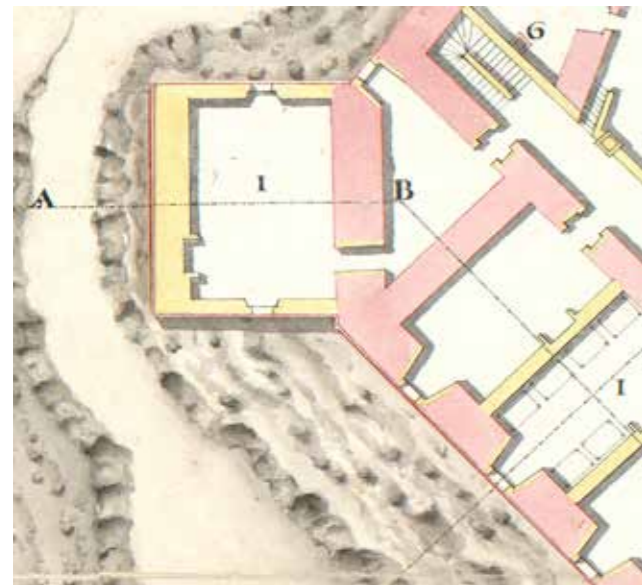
Proyecto de Montaigú. Detalles de planta y sección por la torre suroeste. 1730.
